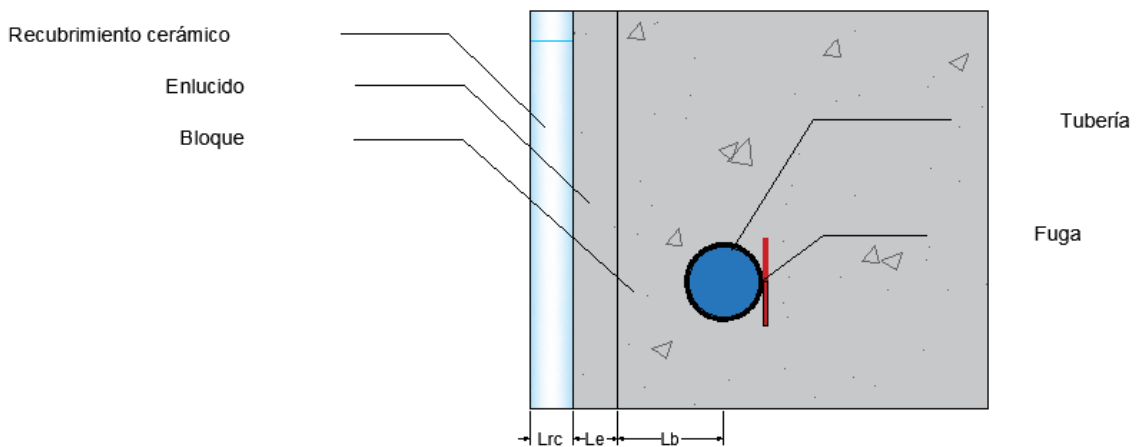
Esquema de vista en perfil de muro y localización de fuga
